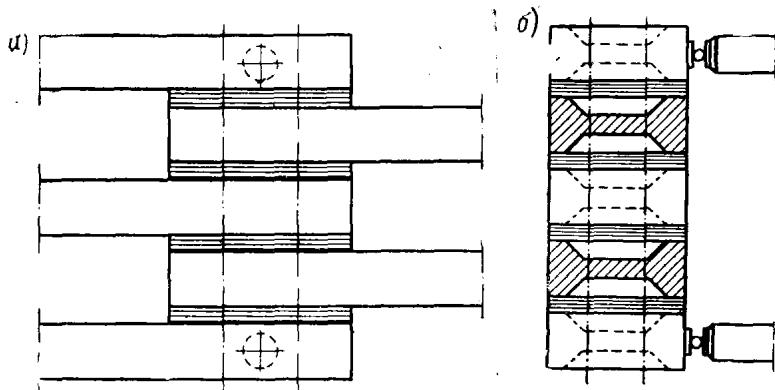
Соединение балок на опоре с укладкой их вразбежку и обетонированием зазоров
